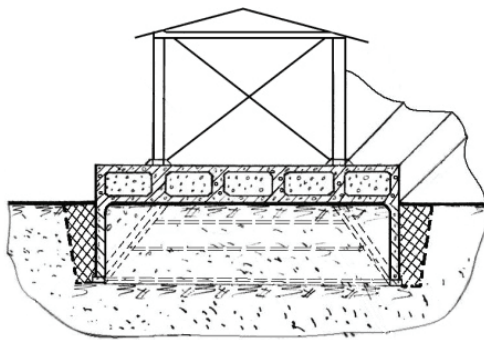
Пространственная фундаментная платформа со «стеной» в грунте под здания и сооружения для строительства на слабых грунтах и в сейсмических районах. Патент РФ № 64650. Между «стеной» и грунтом устроен защитный зазор с «мягким» наполнителем
